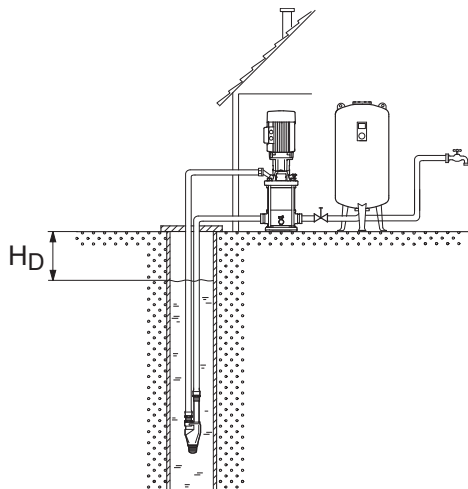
Installation équipée d'une pompe CR(I) pour puits profond
